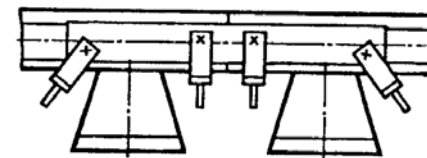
Излом рельсовой плети, перекрытый накладками, стянутыми струбцинами
